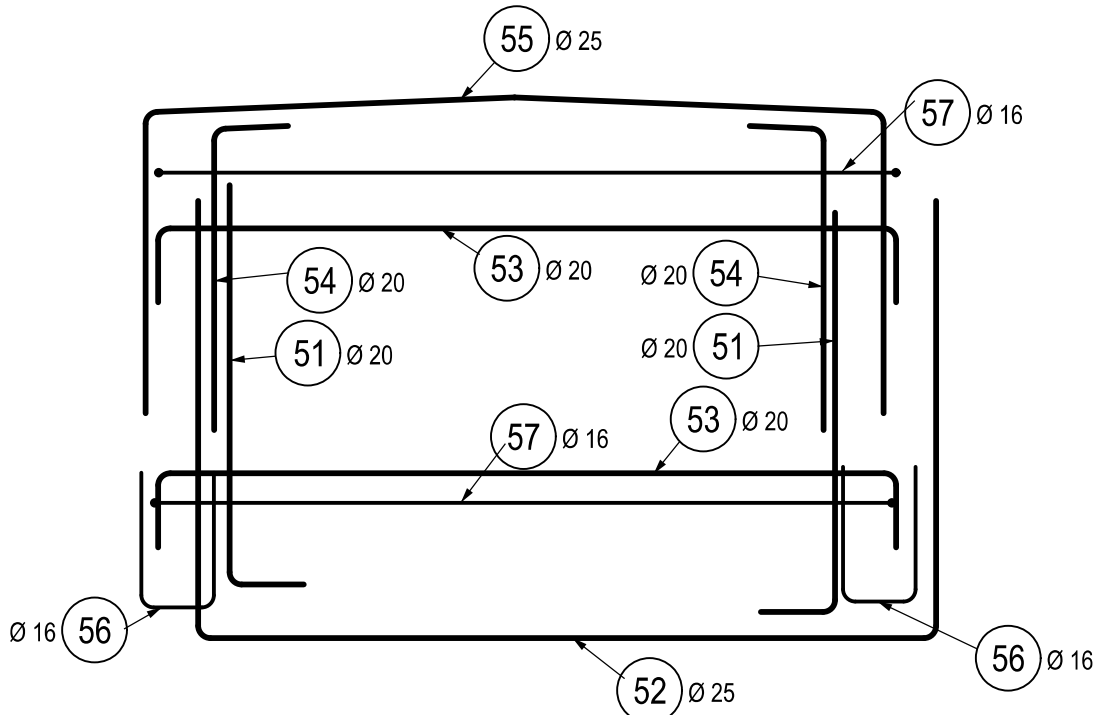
DETAIL VÝZTUŽE POD KOTVOU ZÁVĚSU, 1:25
